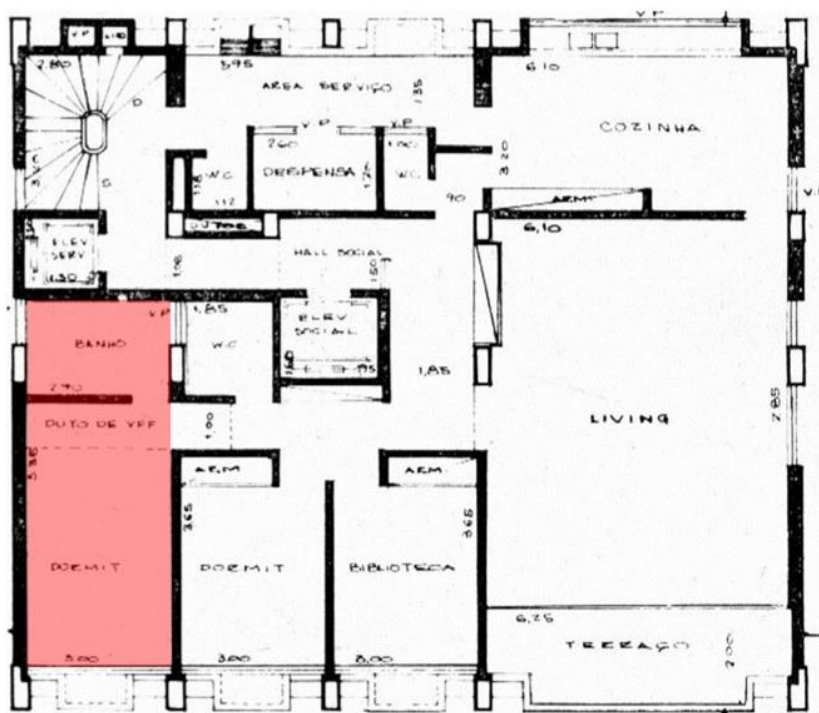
Planta baixa, alameda Rio Claro, Maurício Kogan e Samuel Szpigel, 1961. Adaptação da autora.
